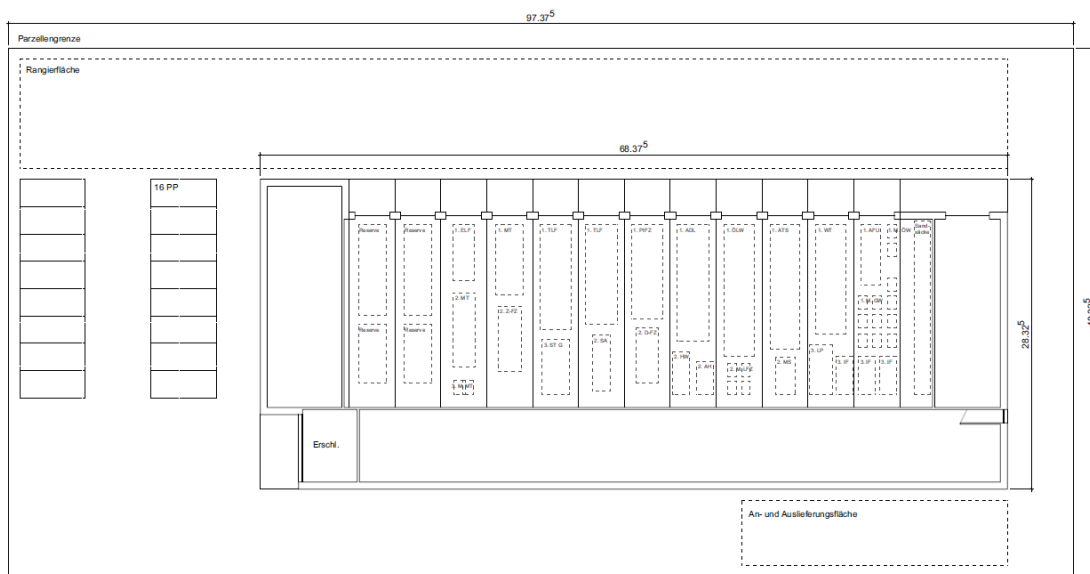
Flächenprüfung Erdgeschoss, Beispielgrundriss
